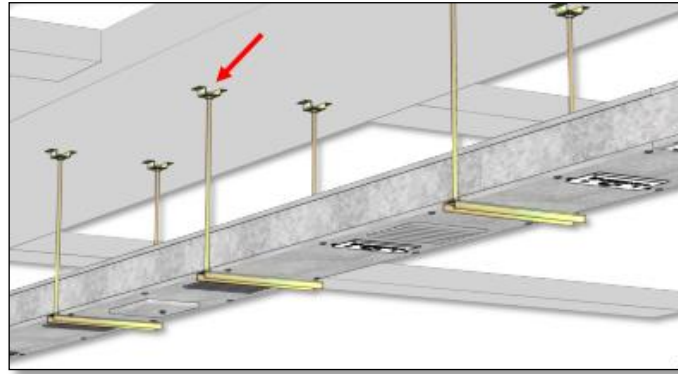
Suportes metálicos com barras roscadas e perfil “U”
